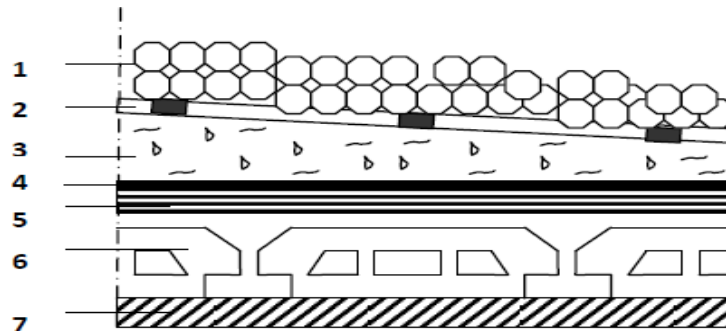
coupe transversale du plancher terrasse inaccessible
